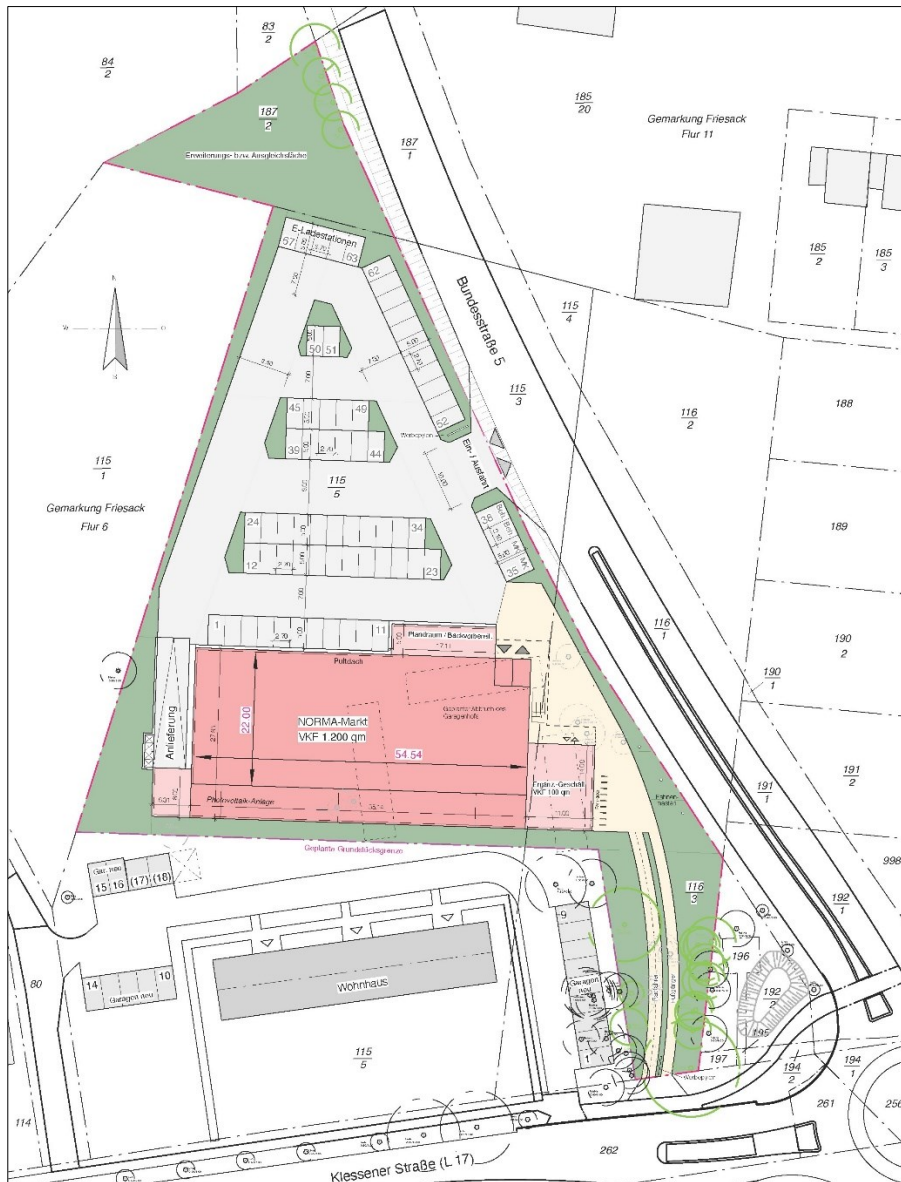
Vorentwurf Vorhaben- und Erschließungsplan "NORMA-Markt an der B 5 / Ecke Klessener Str." der Stadt Friesack; Dipl.-Ing. Arch. Ralf Holtorf, Hampsteadstraße 9, 14167 Berlin, 07/2024
